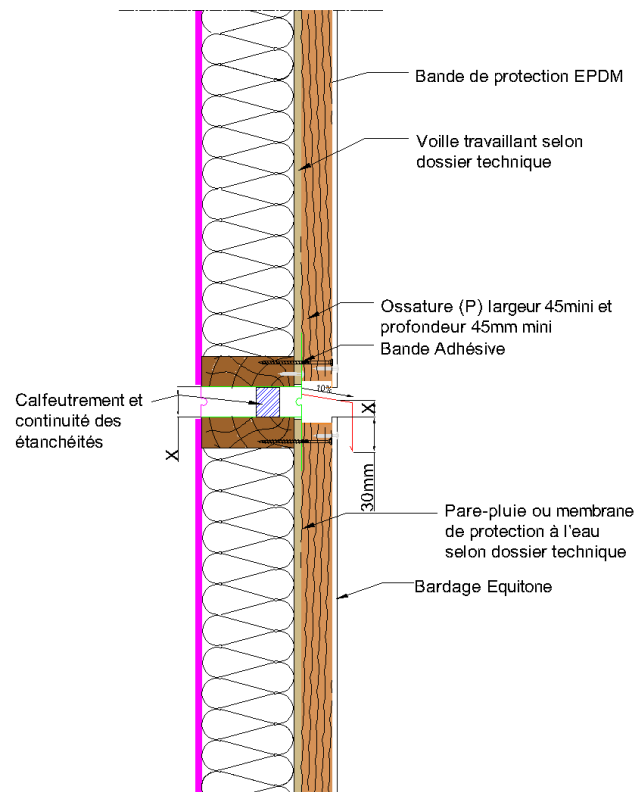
Jeu fonctionnel horizontal, coupe verticale
